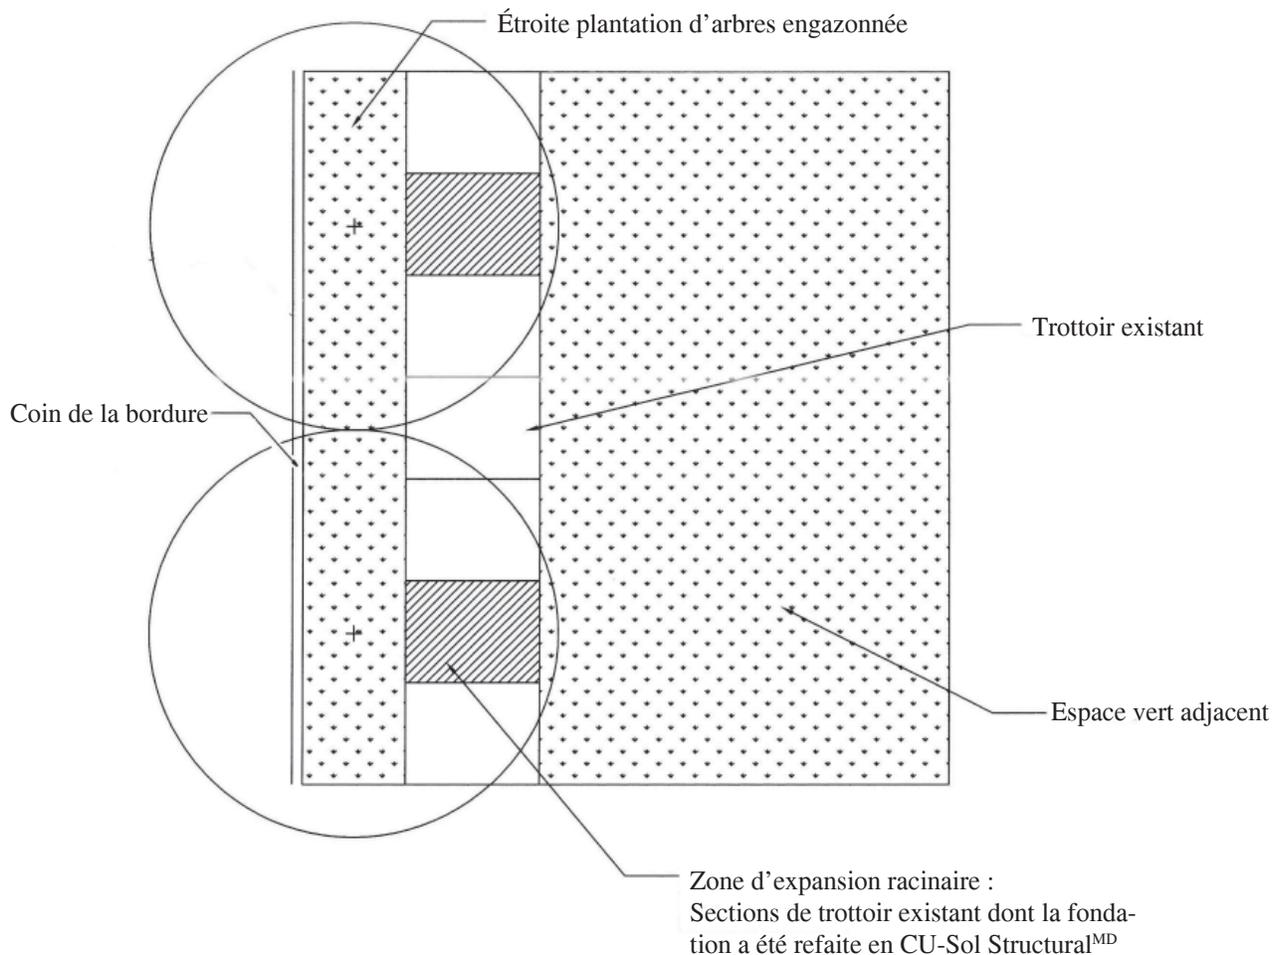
Vue en plan de zones d'expansion racinaire
